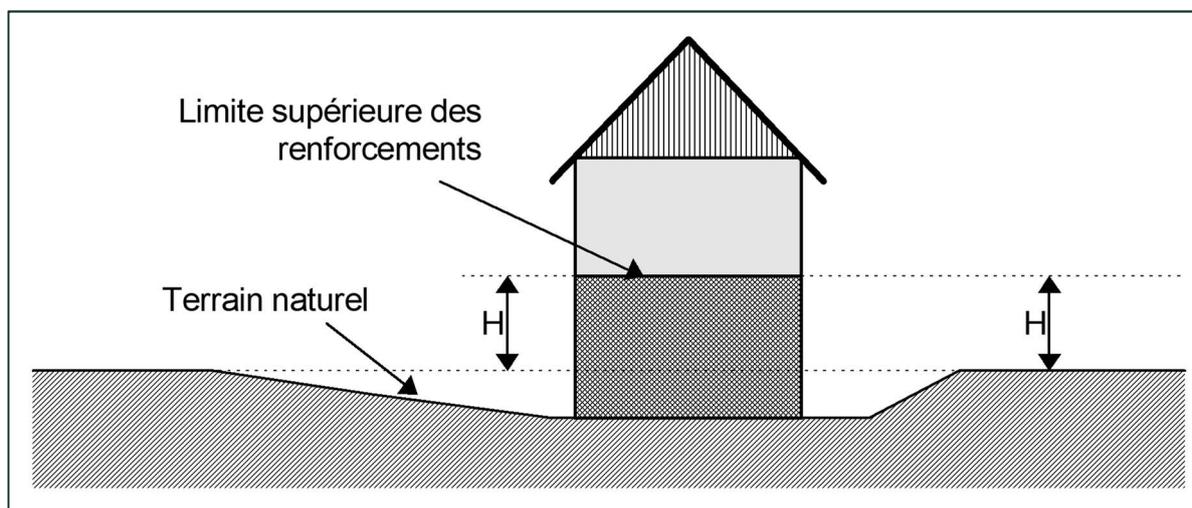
Définition de la hauteur de renforcement pour une construction en cuvette
